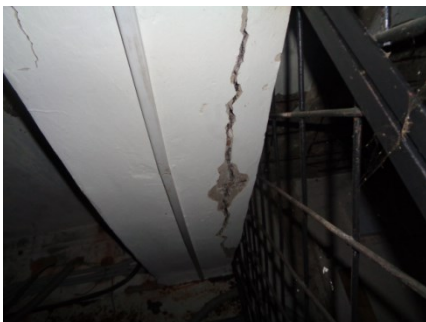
Характерная коррозионная трещина в бетоне железобетонной монолитной балки
